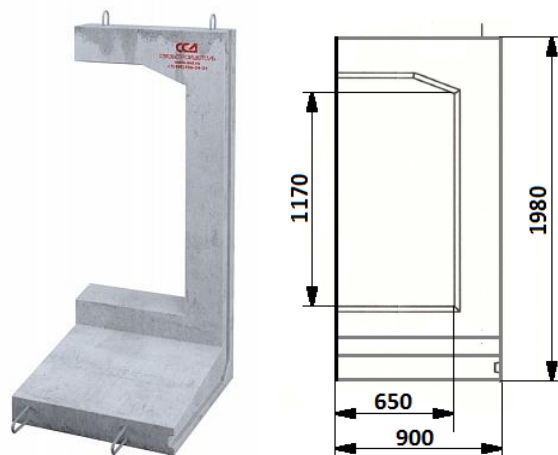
Внешний вид и размеры блока «СБ-2-2».
